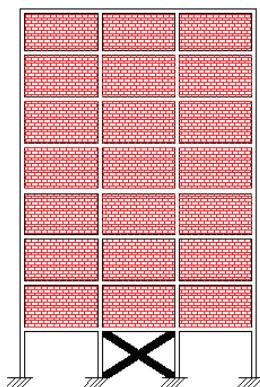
Disposição do contraventamento metálico no edifício PT8 - direção transversal.
